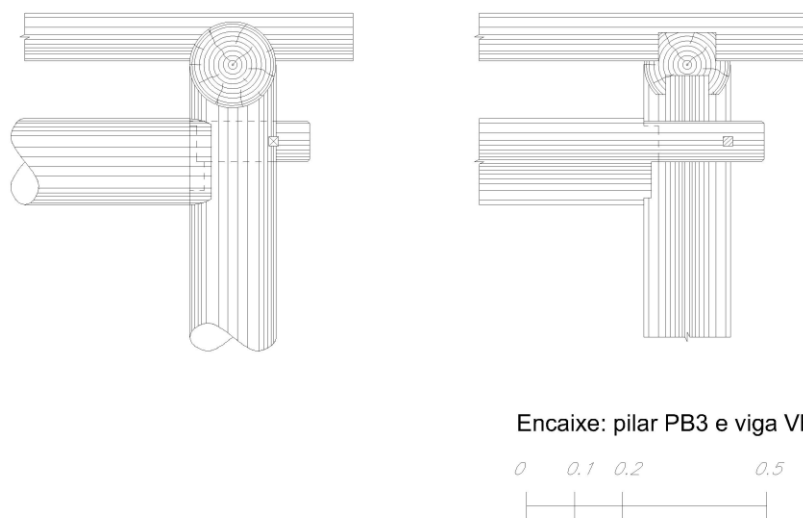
Detalhe do encaixe entre o pilar PB3 e viga VB2. Desenho: Alexander Chang.
